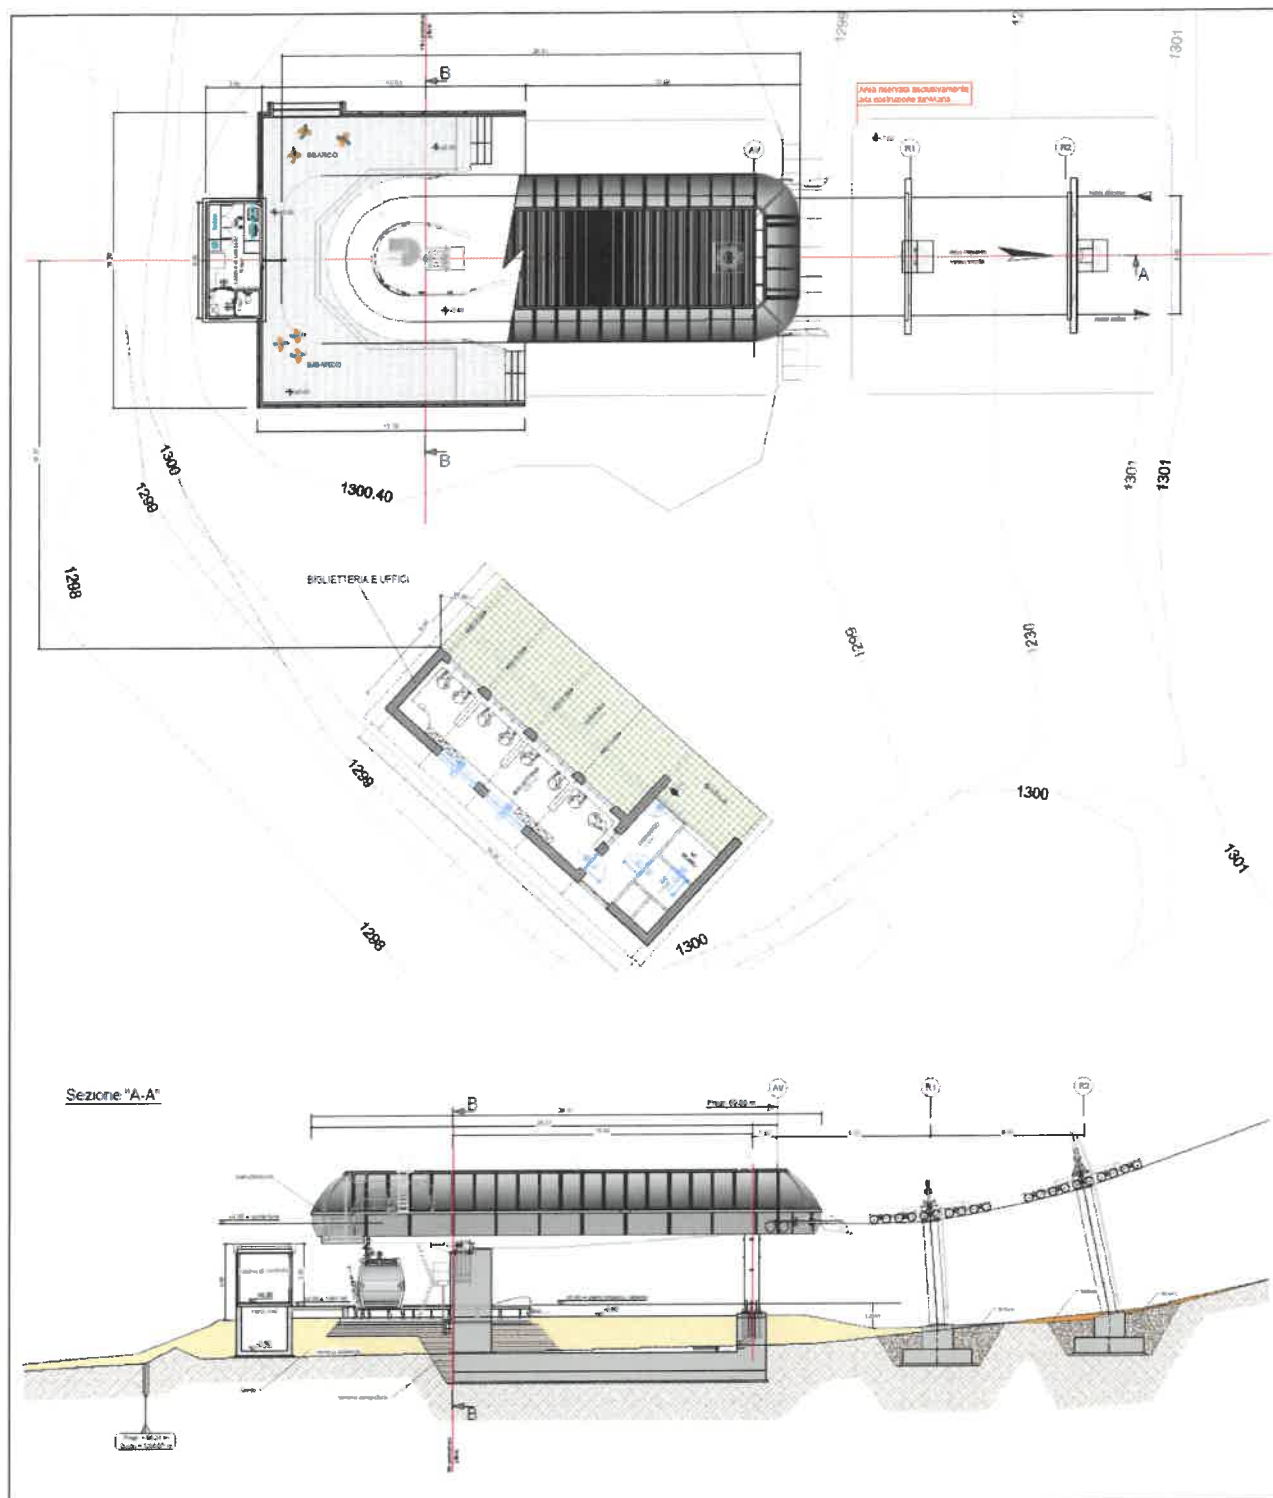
Stazione di valle: pianta e sezione (Elaborato EG12)
